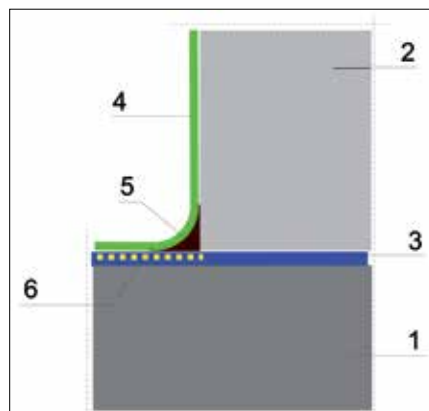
Układ hydroizolacji schodów zewnętrznych (rozpatrywać łącznie z rys. 7 i 8): 1 – fundament schodów lub konstrukcyjny beton podkładowy, 2 – schody (element konstrukcyjny), 3 – izolacja pozioma fundamentu schodów, 4 – izolacja pionowa fundamentu schodów, 5 – hydroizolacja stopni (uszczelnienie podpłytkowe) z elastycznego szlamu, 6 – okładzina schodów, 7 – poziom gruntu
